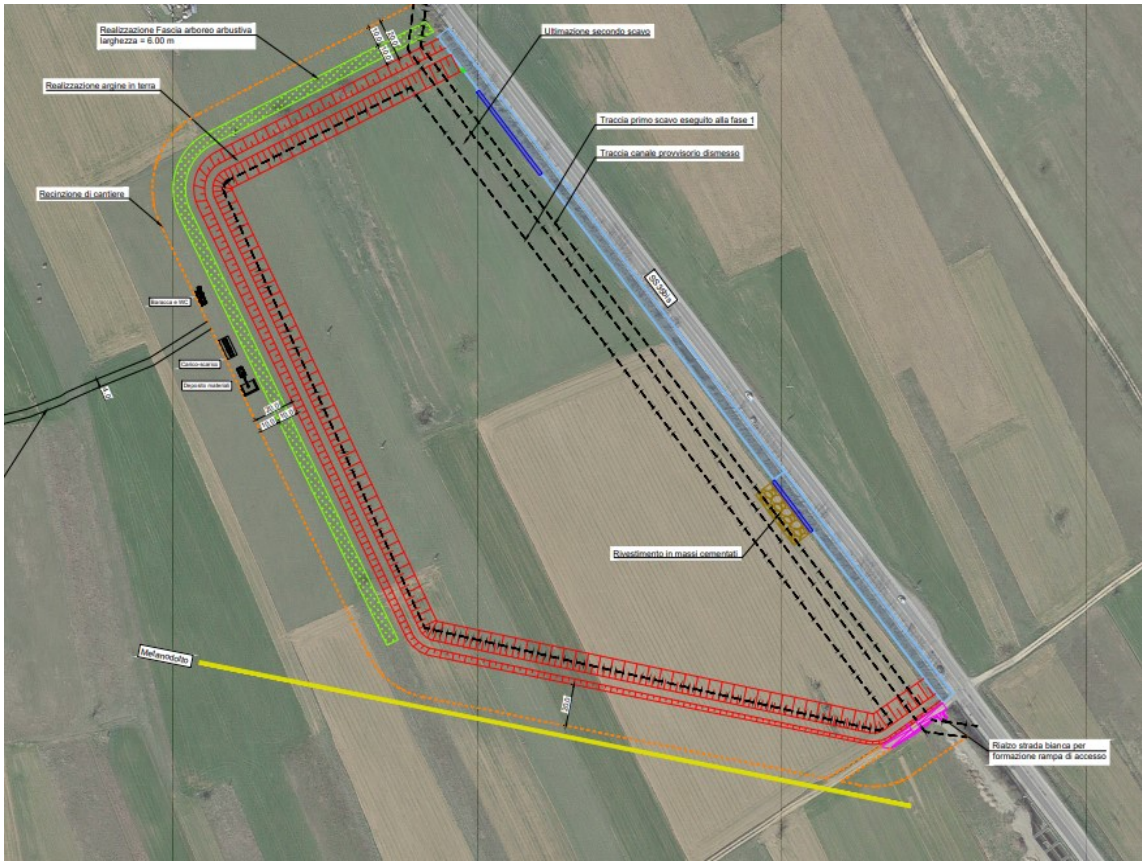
Estratto Tav. 03.1_Planimetria cantiere Fase 1
